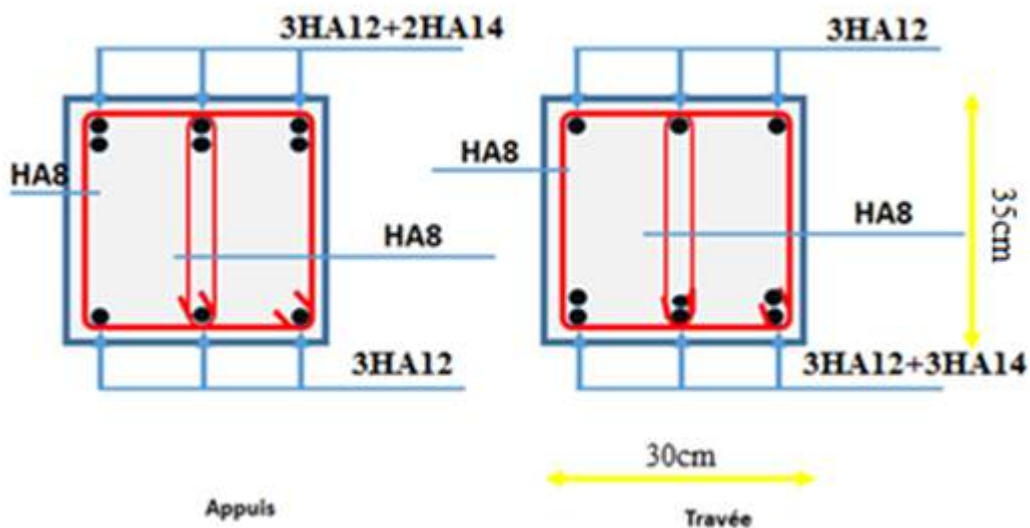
ferrailage de la poutre secondaire plancher terrasse.
